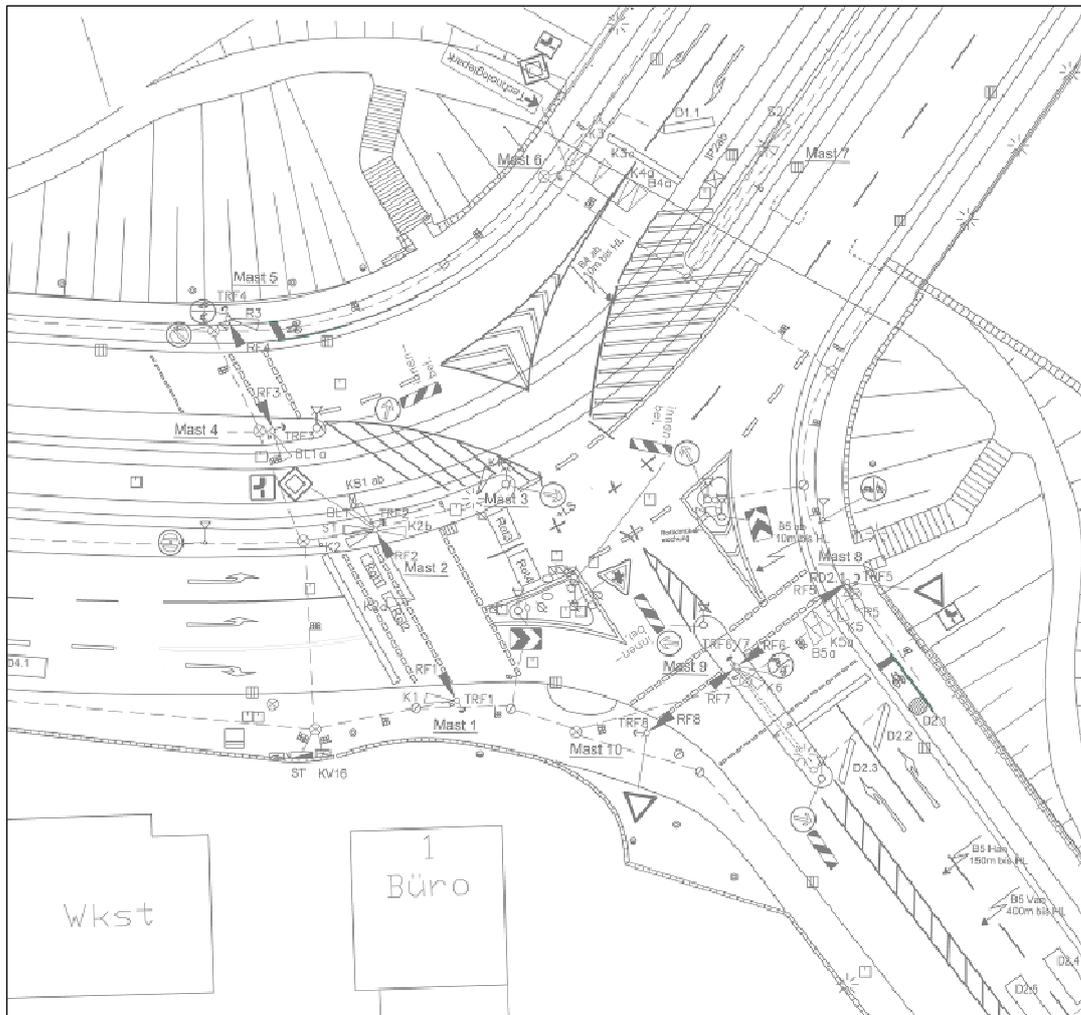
Signallageplan K112 Czernybrücke Status Quo
